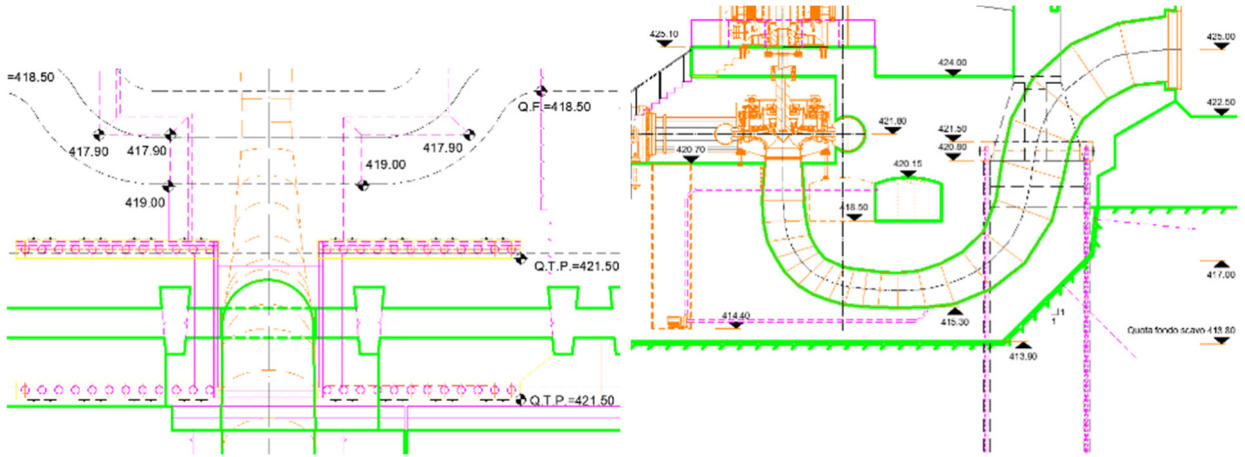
Fase 1, realizzazione di cortine di micropali, vista in pianta ed in sezione
